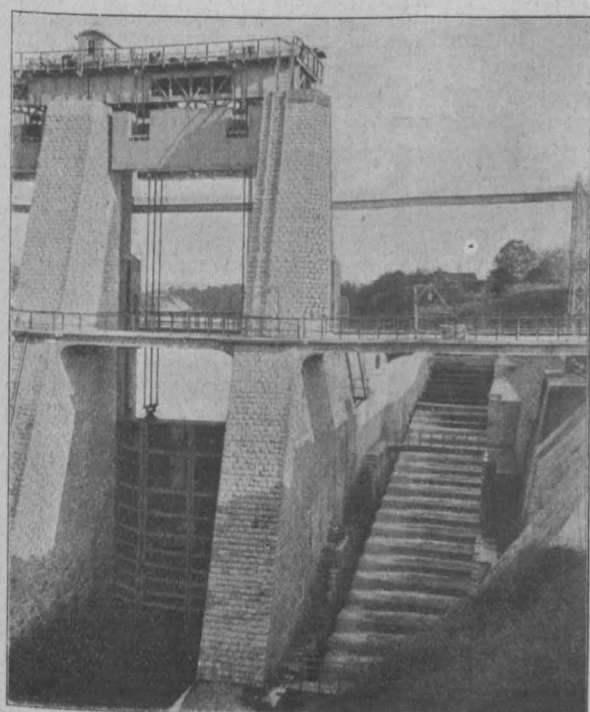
Tuilière, Linke Landöffnung des Stauwehrs mit Fischtreppe
